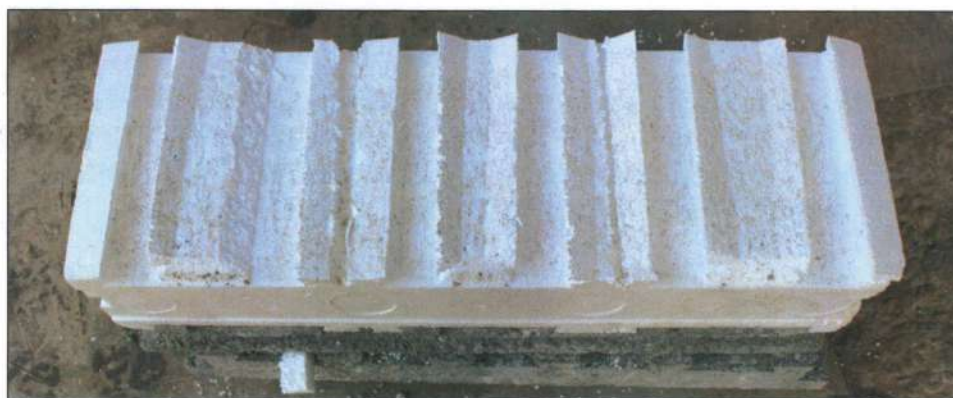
Испытания блоков «UNI» на отрыв бетонных слоев от пенополистирольного вкладыша
